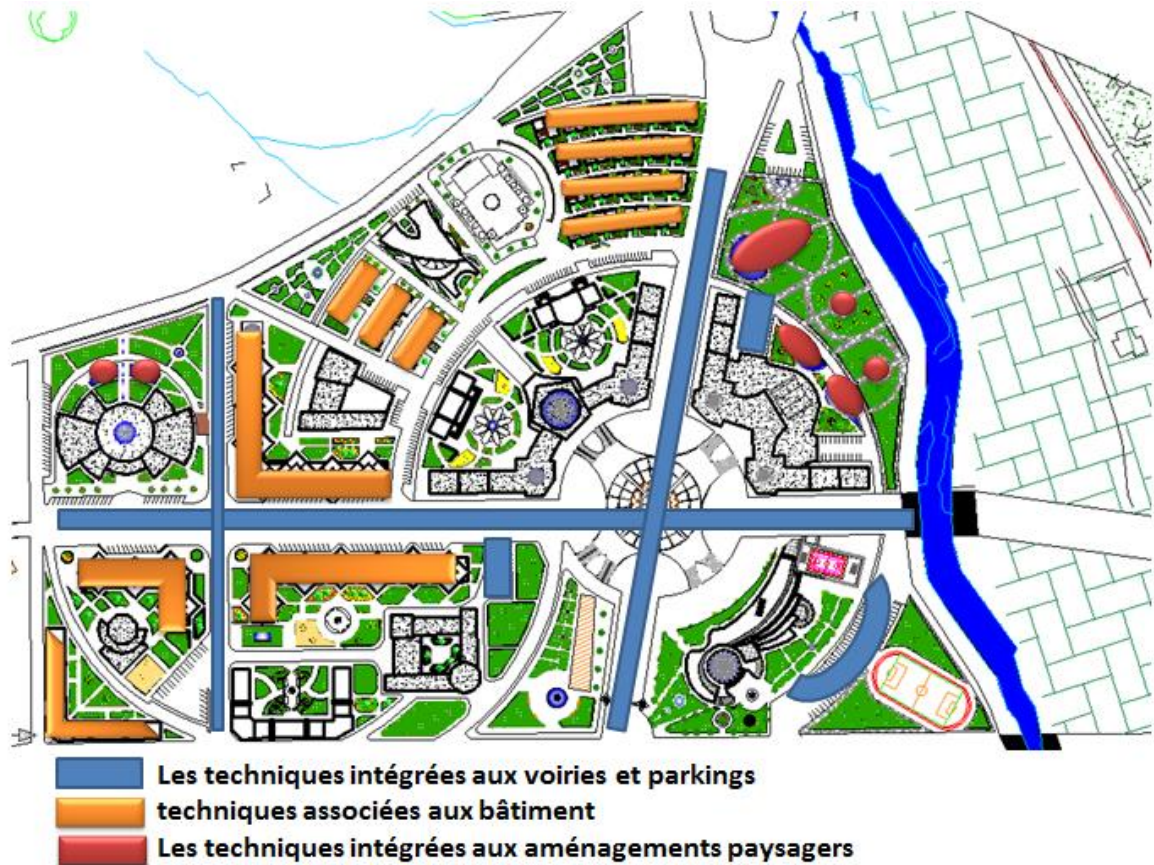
plan des techniques de la gestion des eaux pluviales / source auteur
